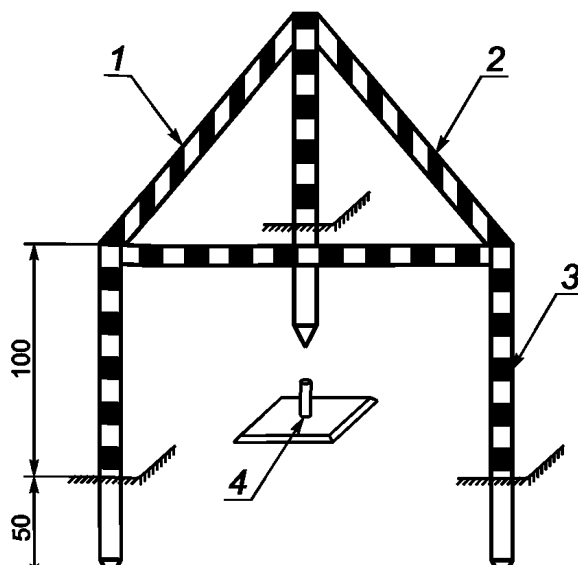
Вид закрепления центра пункта ГРО с использованием винтовой сваи
